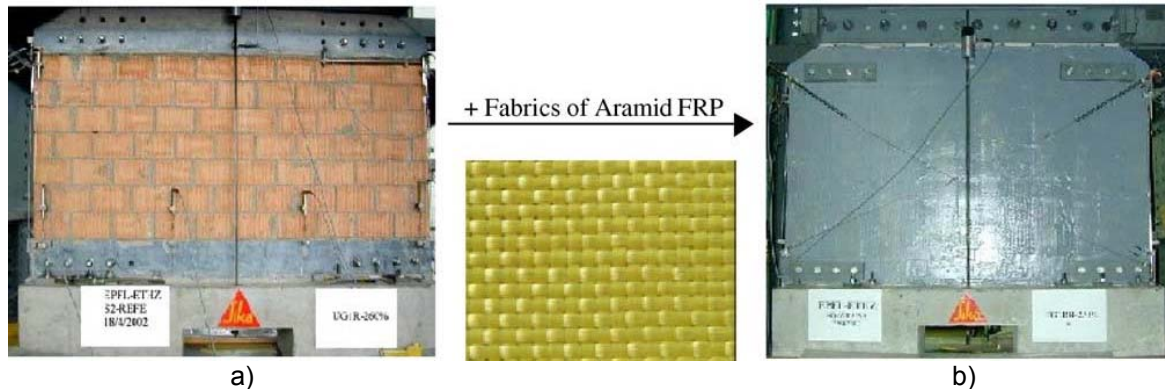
Espécimen de prueba de relación Altura/Longitud menor que 1, con configuración de reforzamiento completa alrededor de todo el muro.
